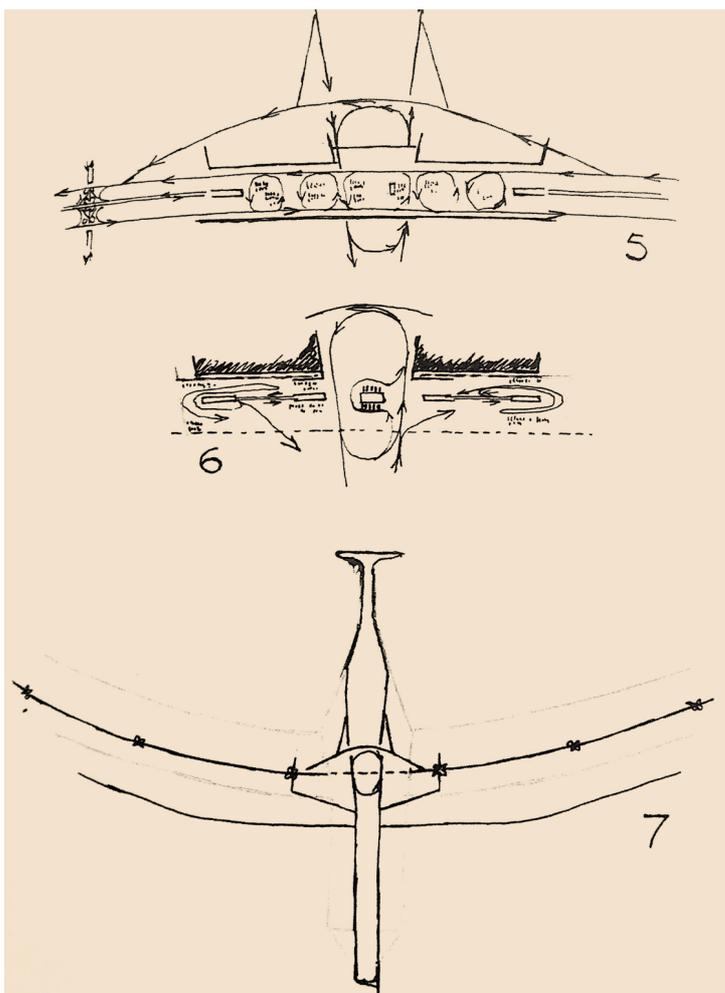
Croquis 05 a 07 apresentados por Lucio Costa para o concurso do Plano Piloto de Brasília, 1957. Nota-se a estruturação viária da Plataforma em dois níveis. Posteriormente foi adicionado um terceiro, mais abaixo, de tráfego ininterrupto no sentido norte-sul. Fonte: Acervo Casa de Lucio Costa
